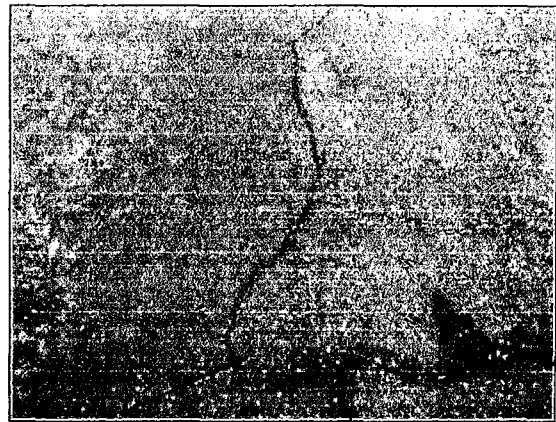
El sello perfecto de las fisuras, de donde nacen nuevas fisuras que se encuentran ramificadas en casi toda la vía.
